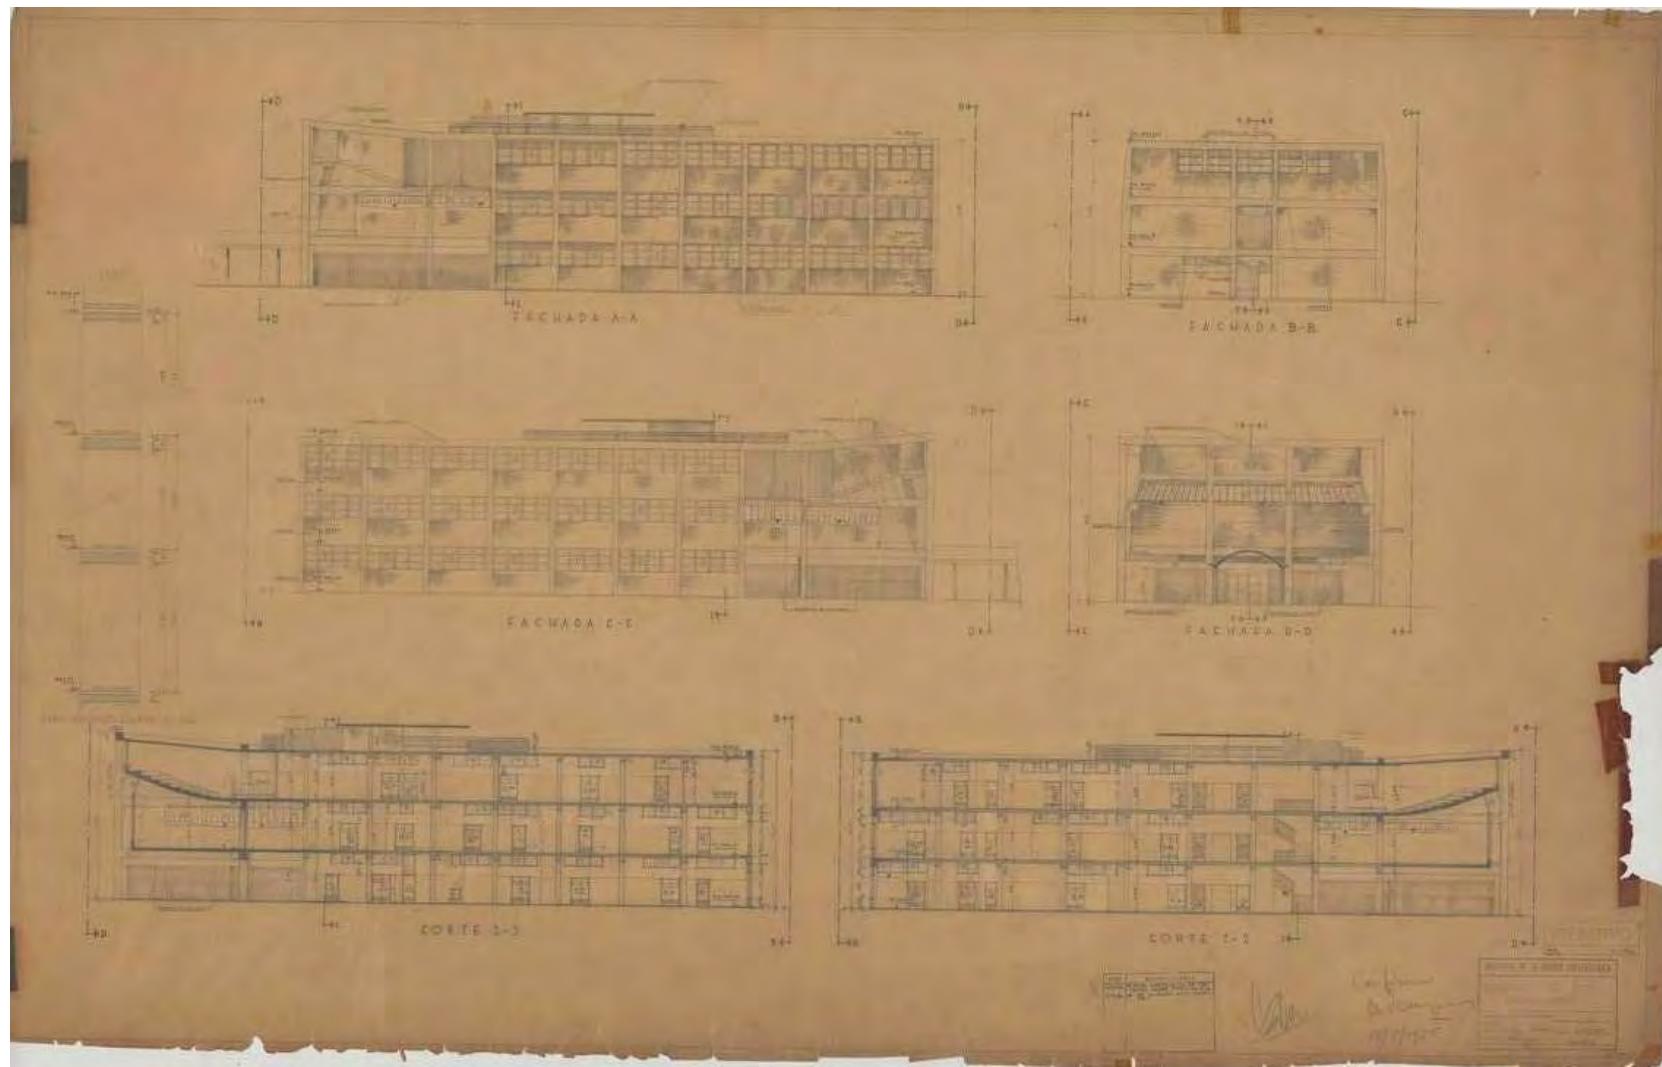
Plano 26-A-2. Fachadas y Cortes Laboratorio de Física Escuela de Ingeniería. Fuente: Colección CUC-ICU / COPRED-UCV.
